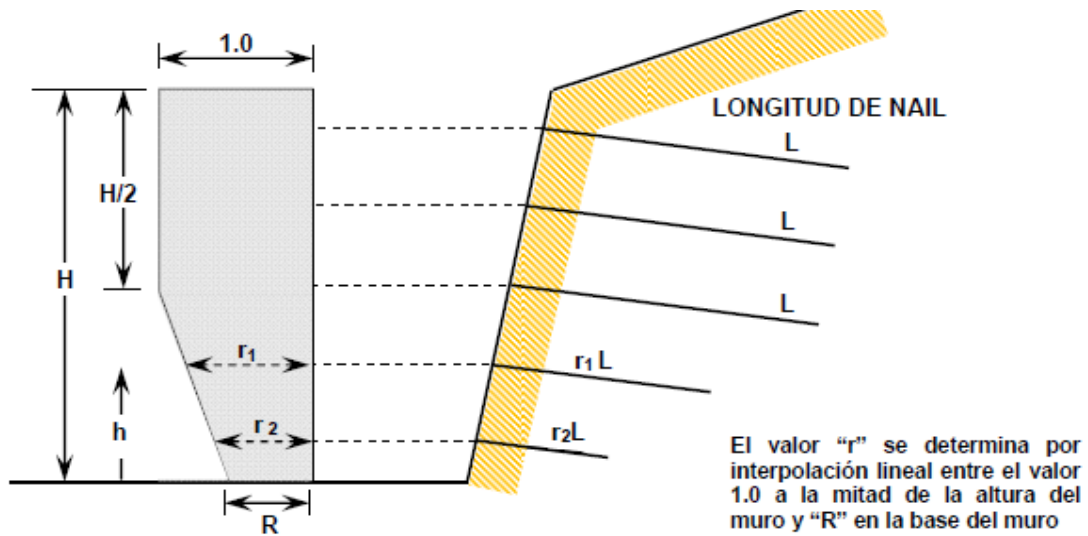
Variació de la longitud de los Nails según la elevación dentro del muro.
